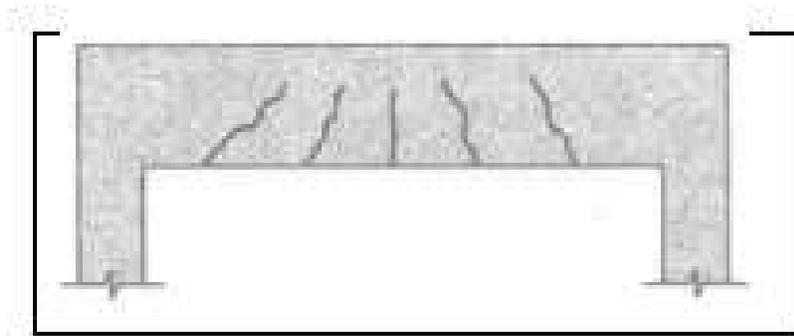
Fisura en Muro de Albañilería
